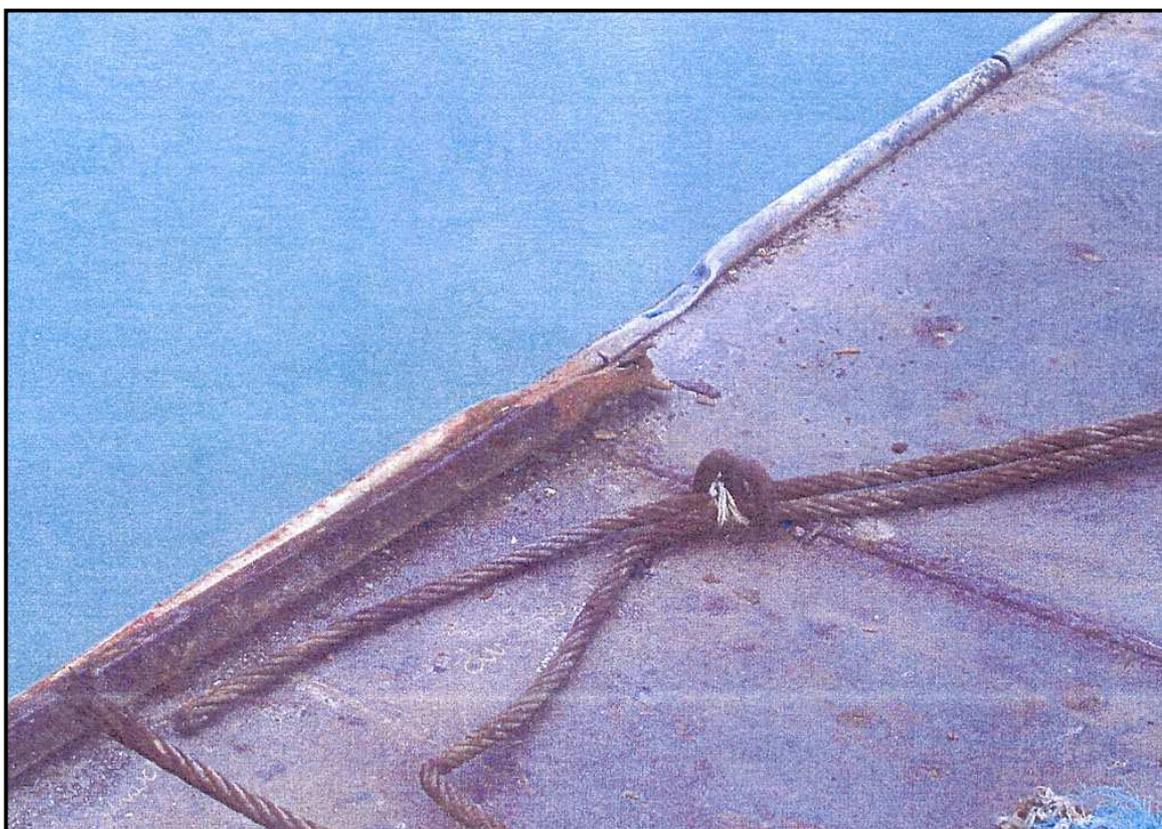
Rampe ro-ro - Passage de cables endommagé.
